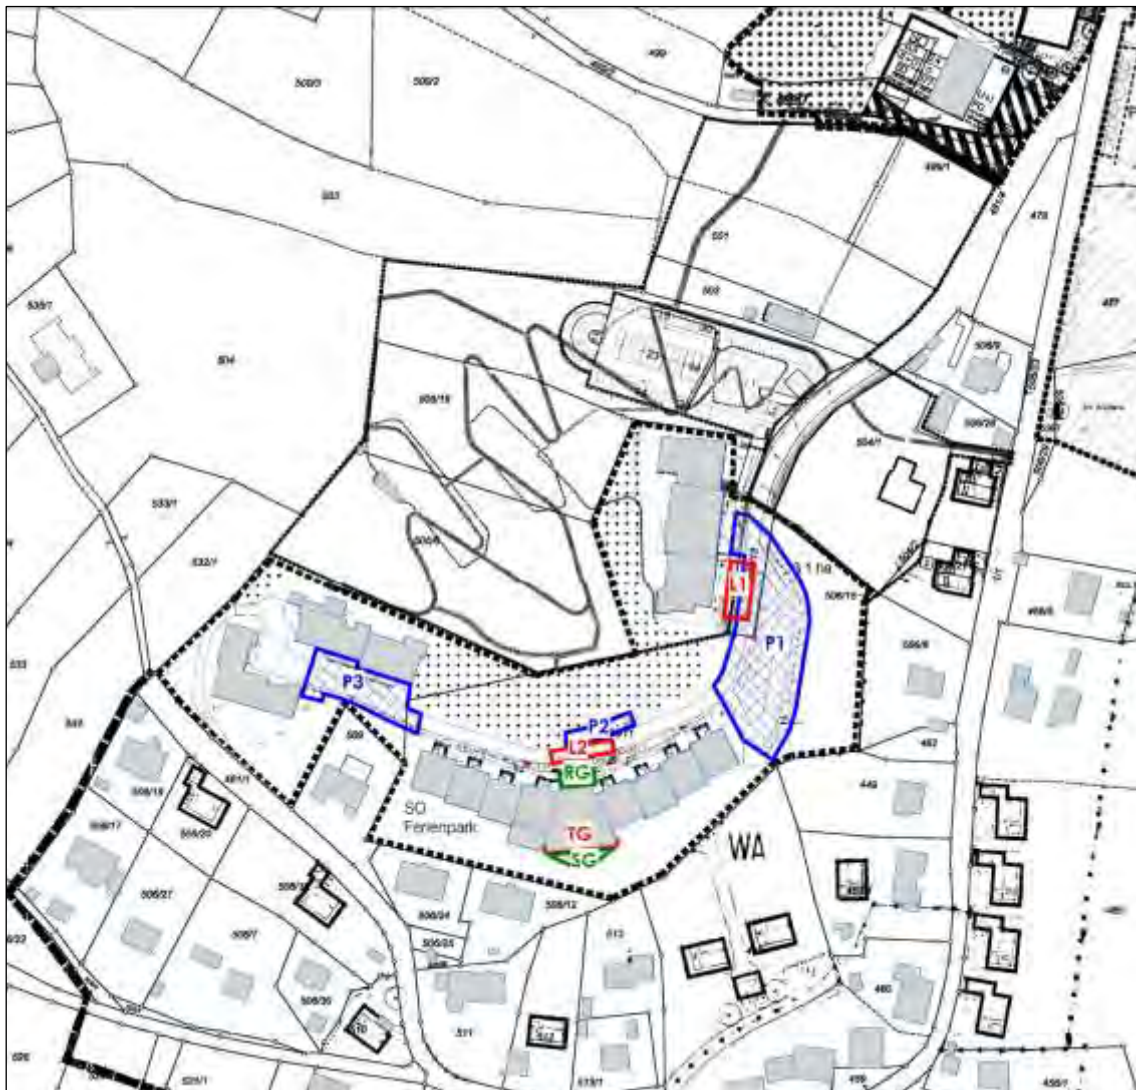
Lageplan mit Darstellung der Schallquellen im SO "Ferienpark Geyersberg "
